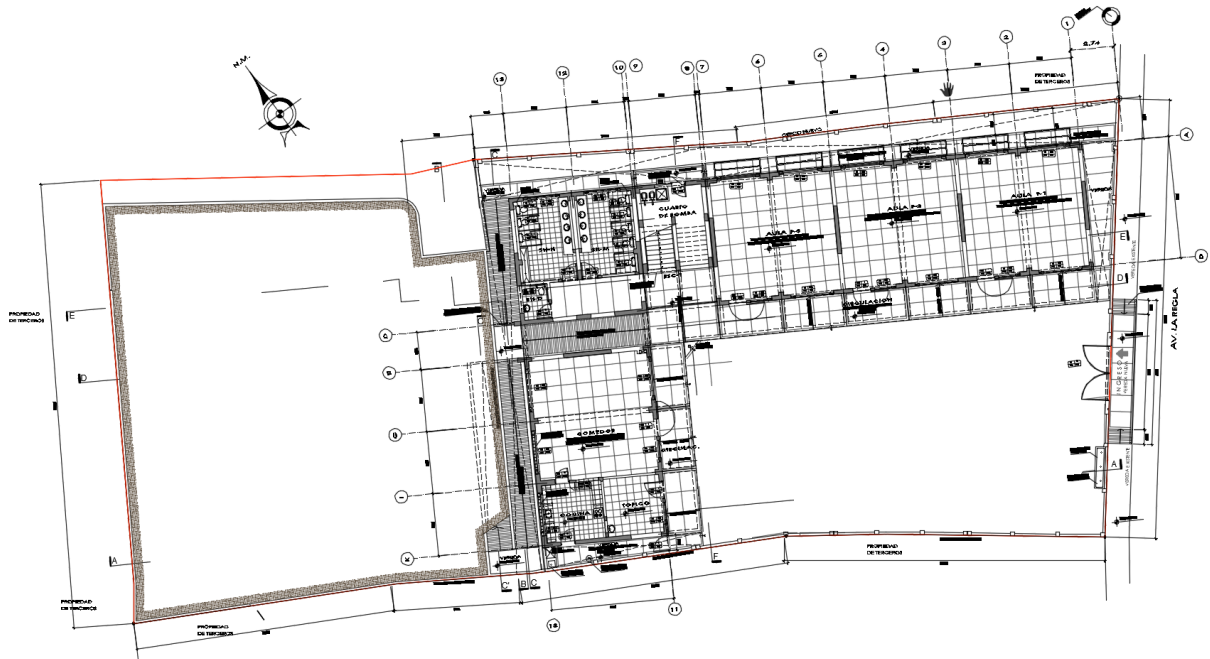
Vista en planta de la I.E. N° 2093 Santa Rosa. Fuente: Elaboración Propia.
